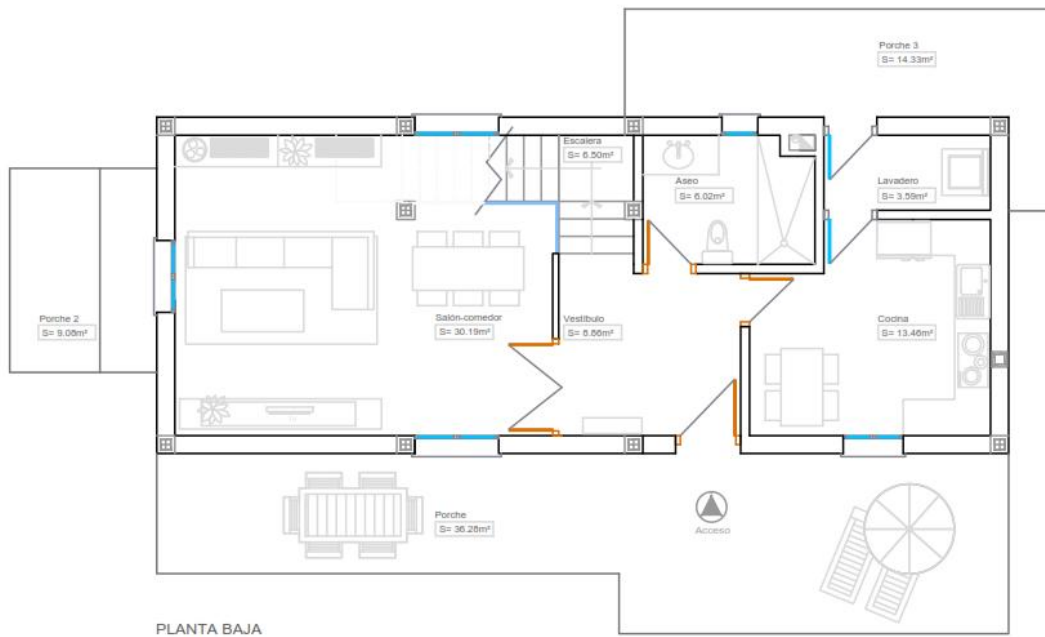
Plano de distribución de la planta baja del inmueble objeto.
